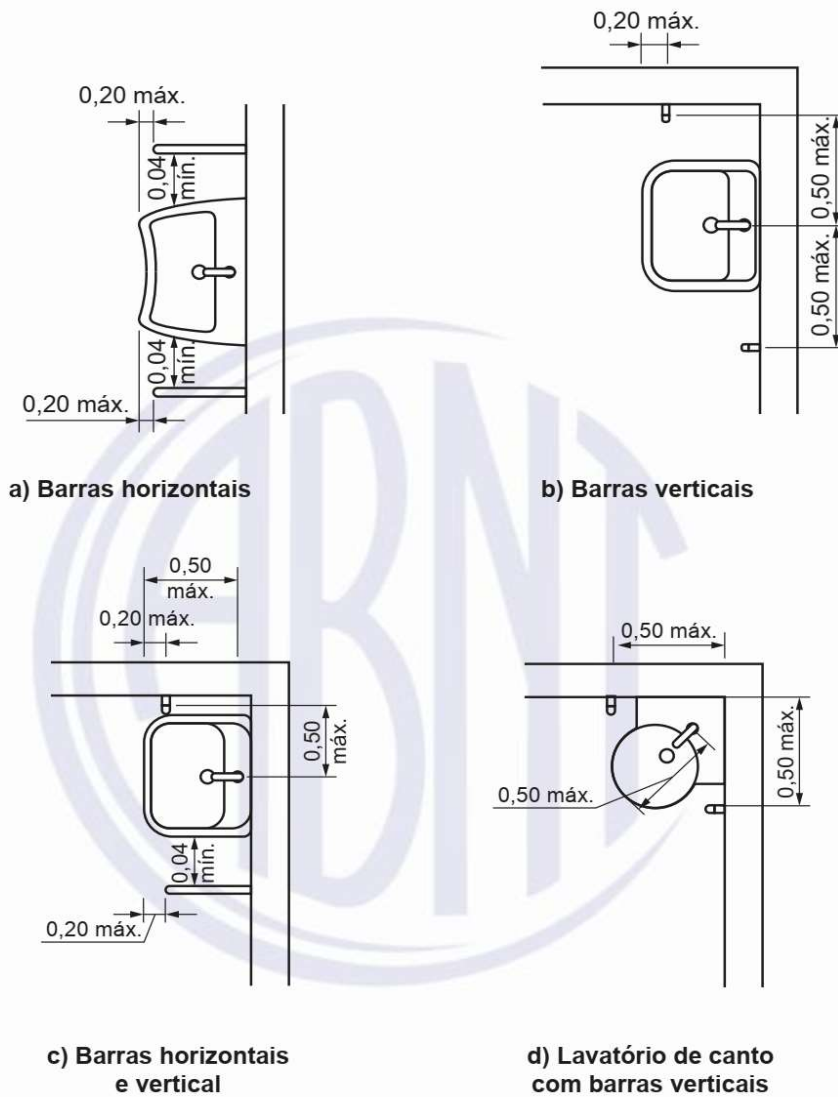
Barra de apoio no lavatório – Vista superior (continua)
